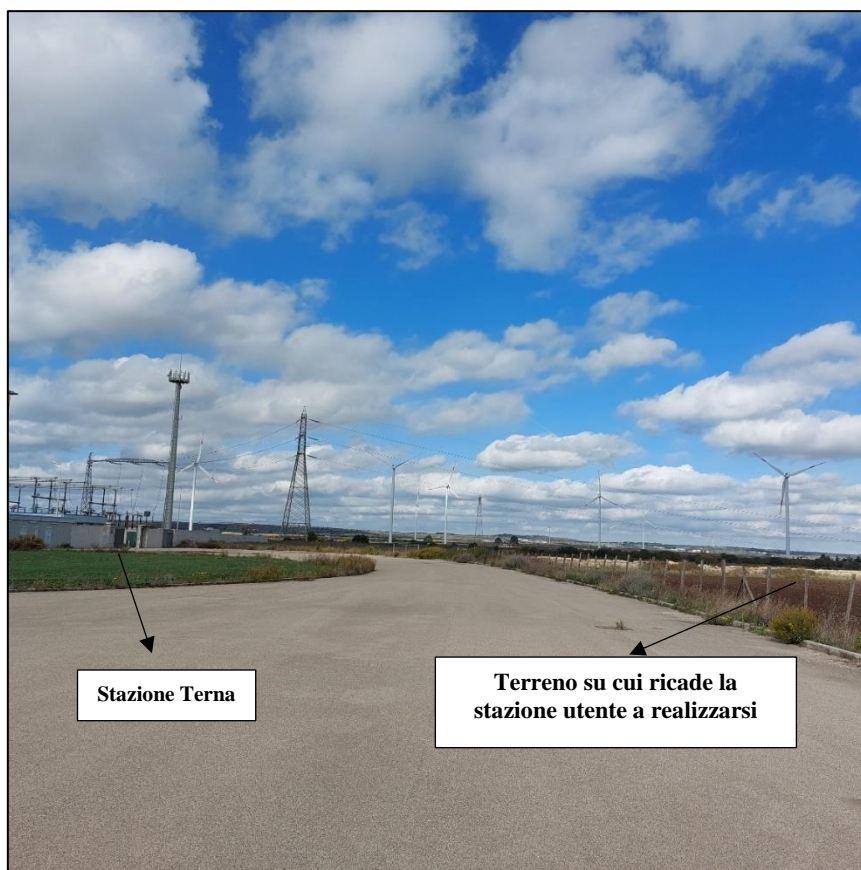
Ubicazione della stazione utente rispetto alla stazione elettrica Terna
